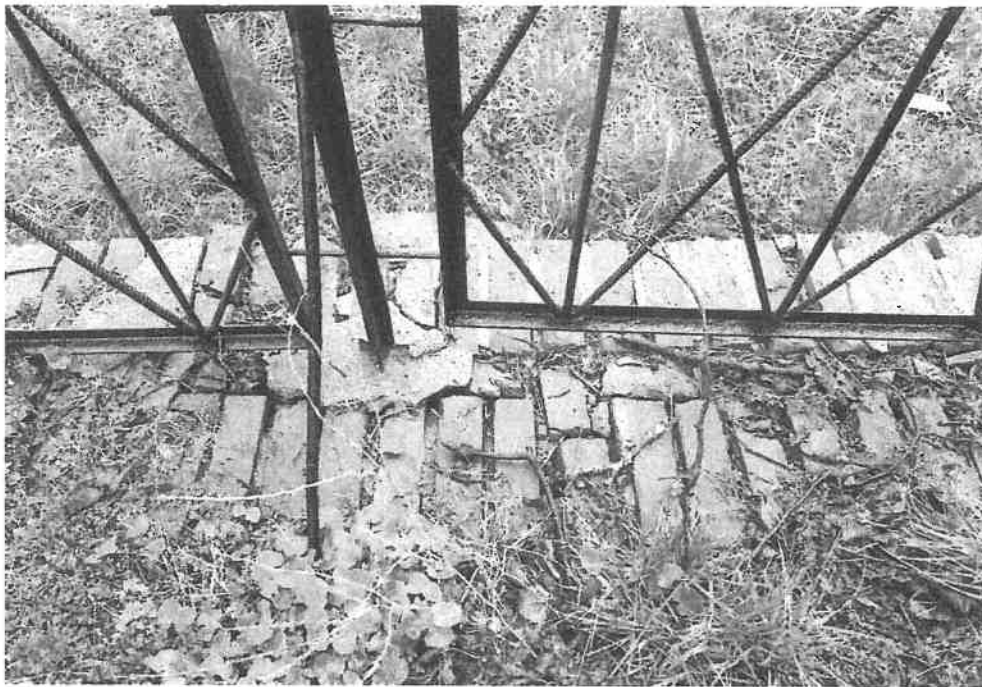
Runowo, widoczne ubytki spoin w kamiennym murze oraz wtórne betonowe nakrywy.
